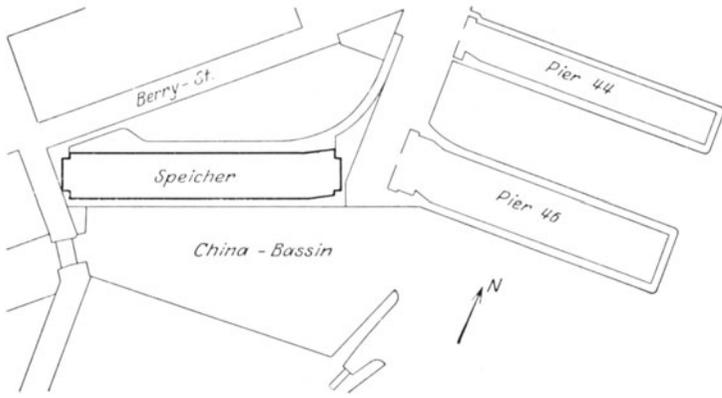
Lageplan des China Basin Terminal mit dem großen Transitschuppen-Kaispeicher.
